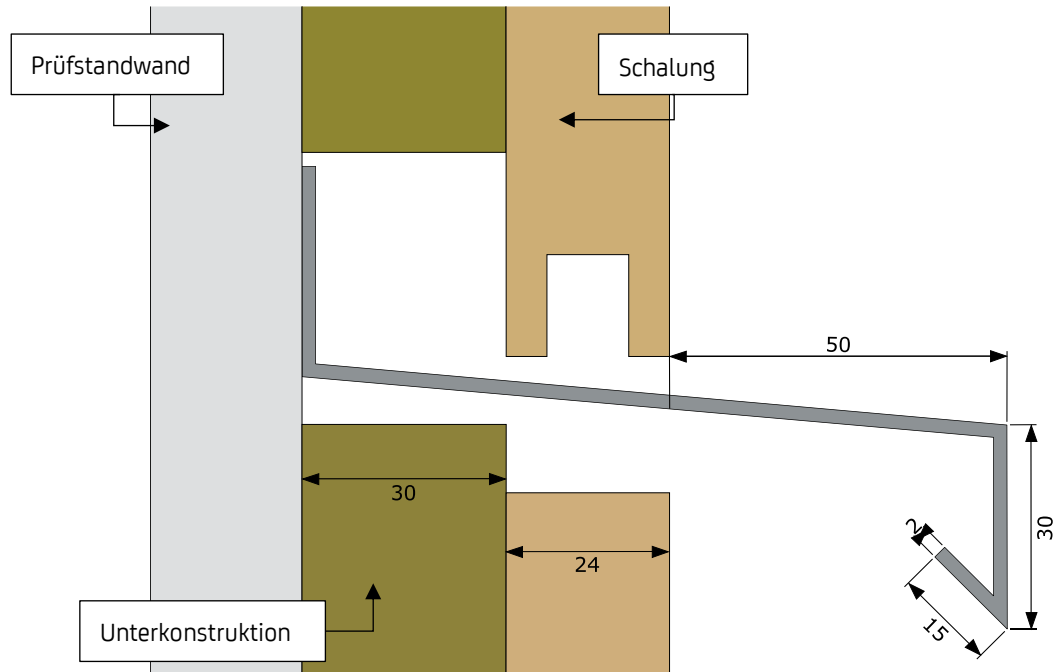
Detailansicht der Ausführung der Brandsperren.
